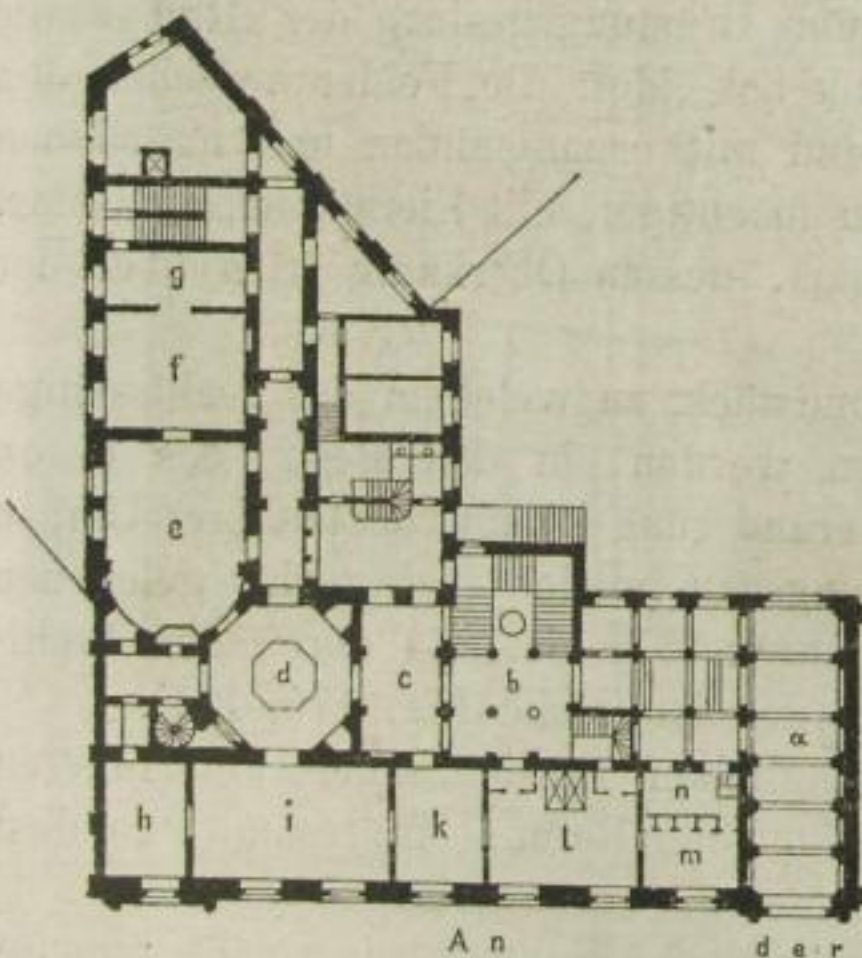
Parterreplan. Das Palais Oppenheim. Fig. 169. Etagenplan.
